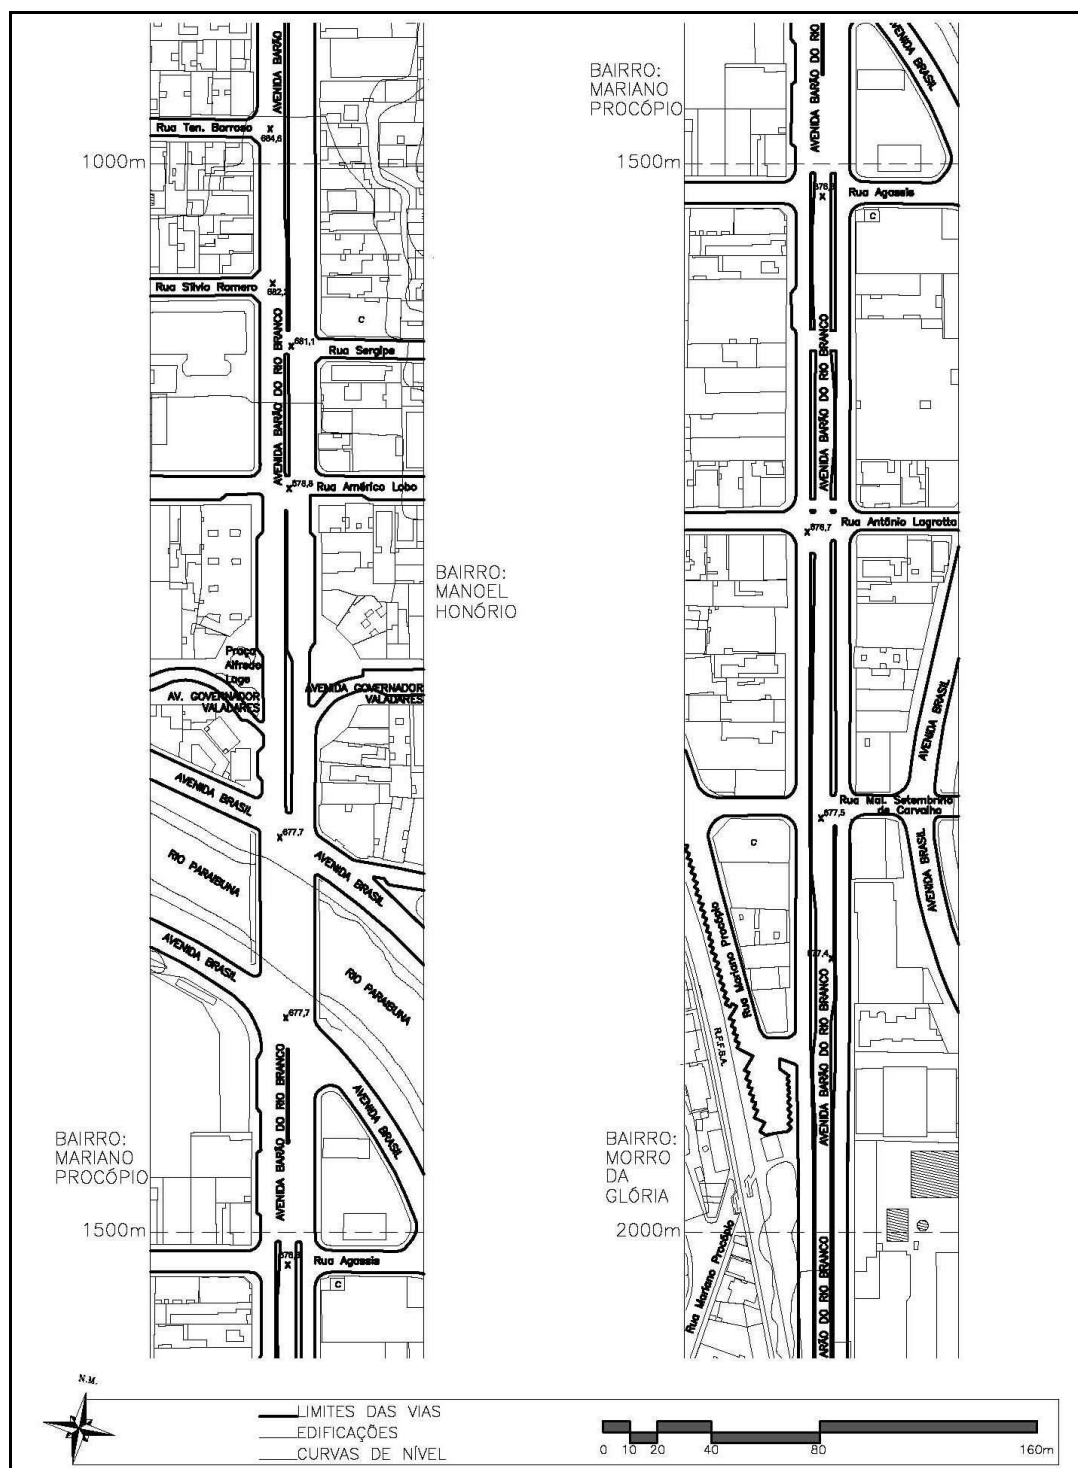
Avenida Barão do Rio Branco – segundo quilômetro.
